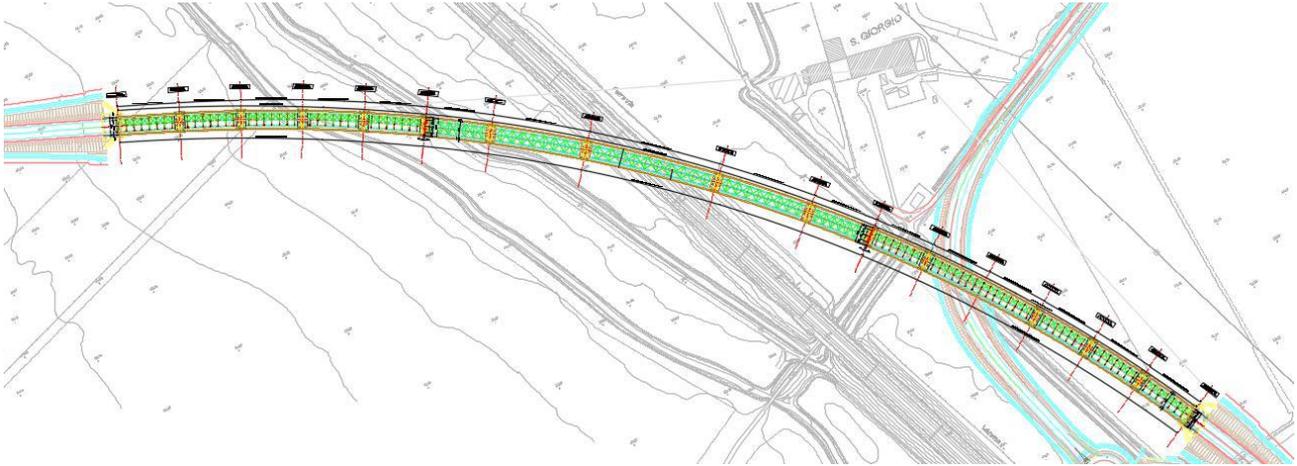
Planimetria cavalcaferrovia San Giorgio
